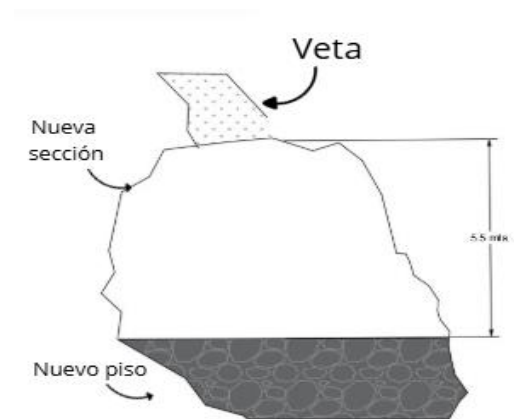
Vista transversal de rebaje con dimensiones estandarizadas.
